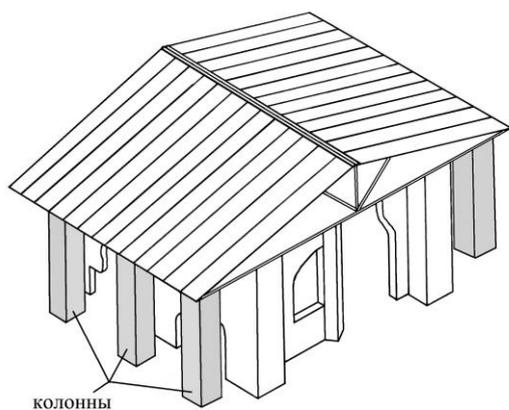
Схема устройства защитной конструкции с опиранием на колонны
